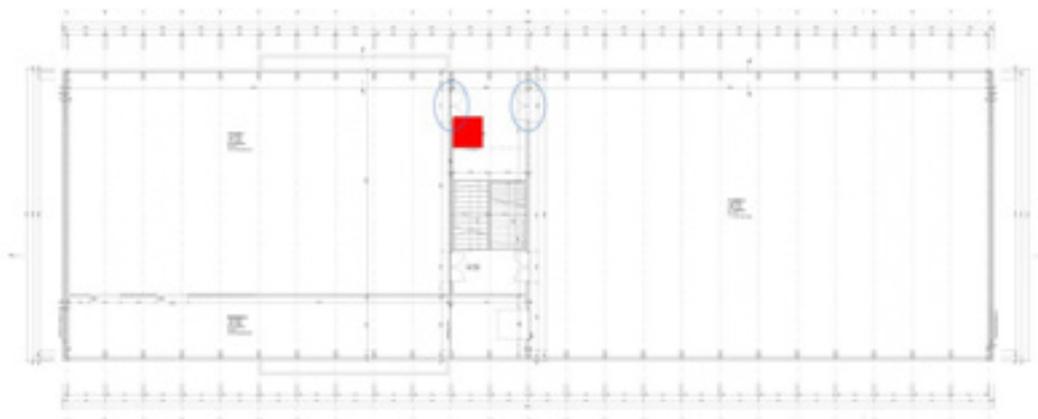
Schwabgut Turnhallentrakt, Grundrisschema Erdgeschoss mit rot eingezeichnetem Liftstandort. Blau markiert sind die Hallentüren, die bei dazu verschoben werden müssen.
